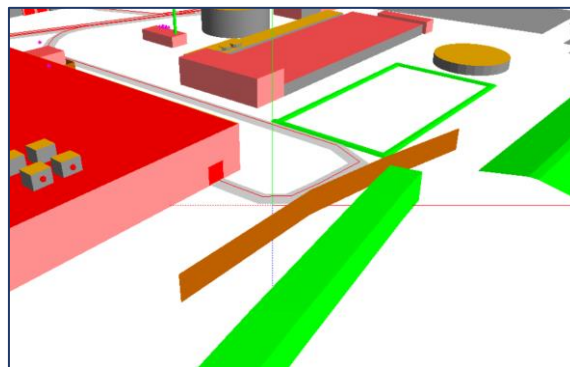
Posizione planimetrica barriera e vista tridimensionale
